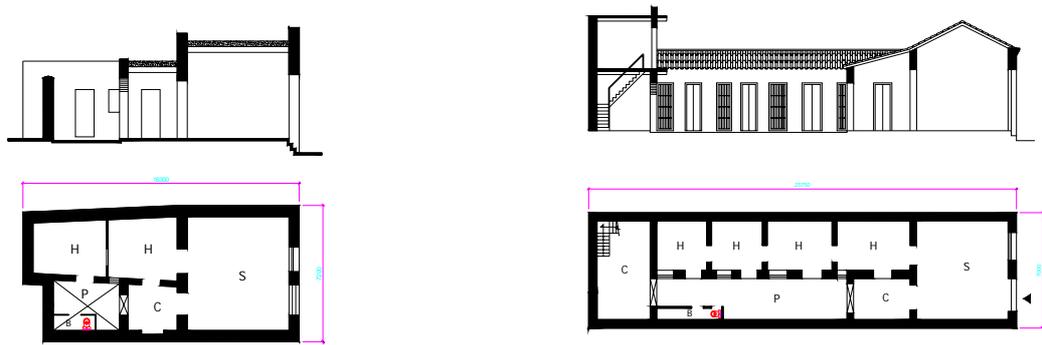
Arriba a la izquierda, Damas 869, planta y sección.
